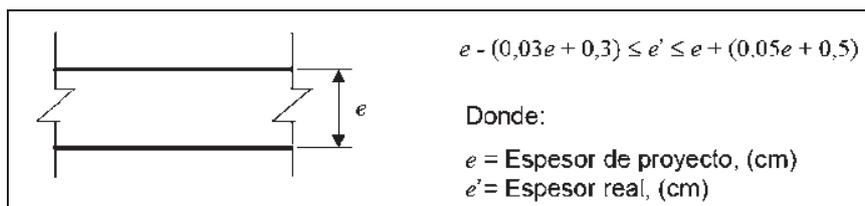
Tolerancia para el espesor de zapatas, losas, muros y cascarones [16].
